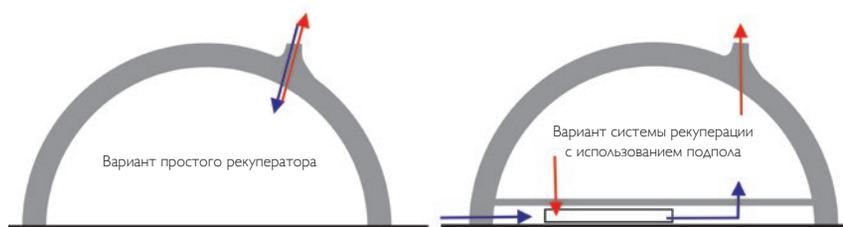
Схемы внедрения системы приточно-вытяжной вентиляции в здании, напечатанное на 3D-принтере
